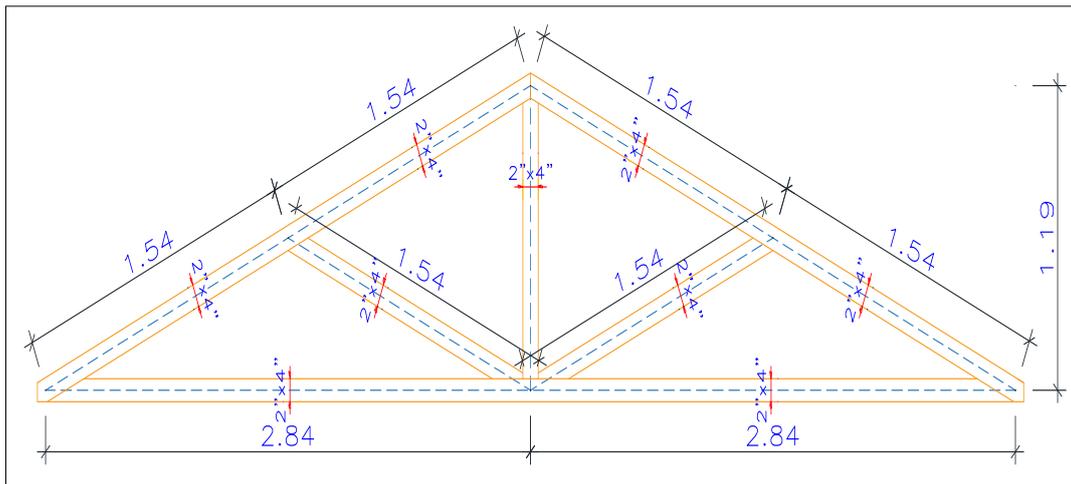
Armadura tipo montante maestro dimensionada
